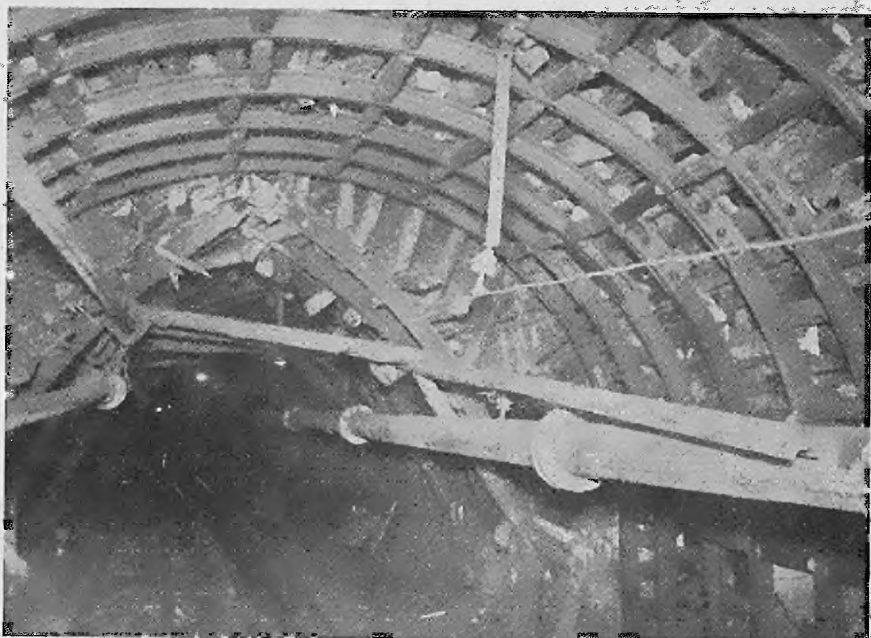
Dreiteiliger Gestellbogensausbau aus Pofaleisen in starrer Ausführung Nachbauen einer zusammengedrückten Förderstrecke
